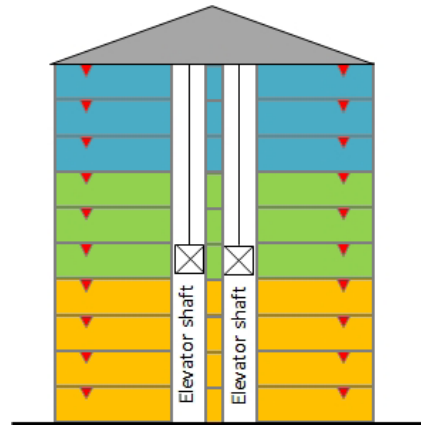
Coupe transversale du bâtiment le plus haut avec deux cages d'ascenseur
